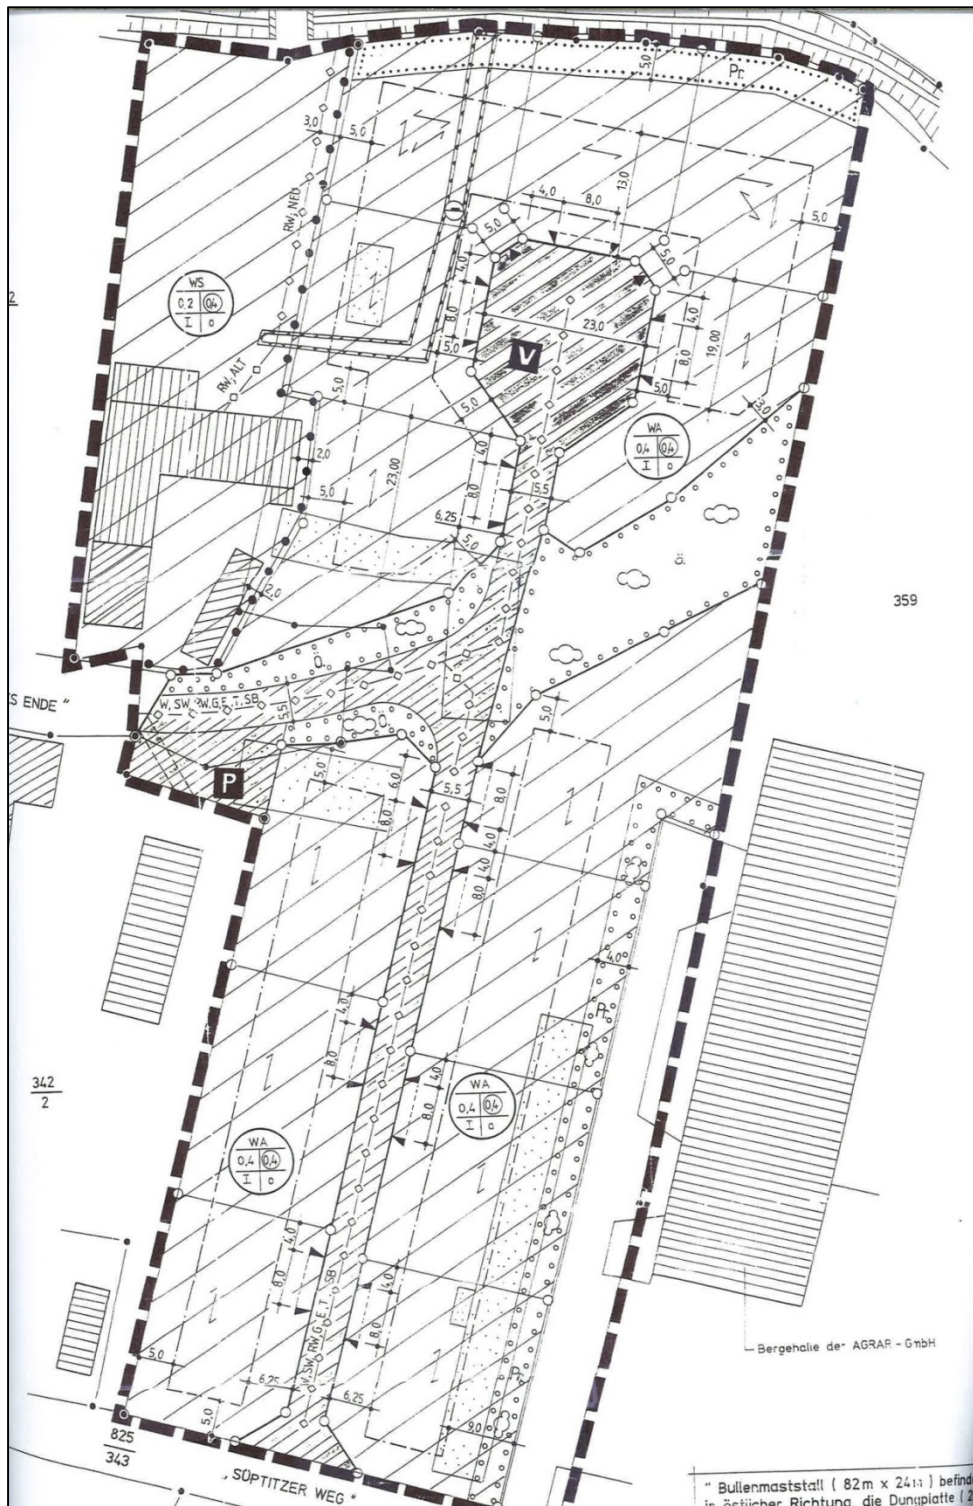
Planzeichnung B-Plan „Grünes Ende“ (12.02.1998), Details siehe dort.
